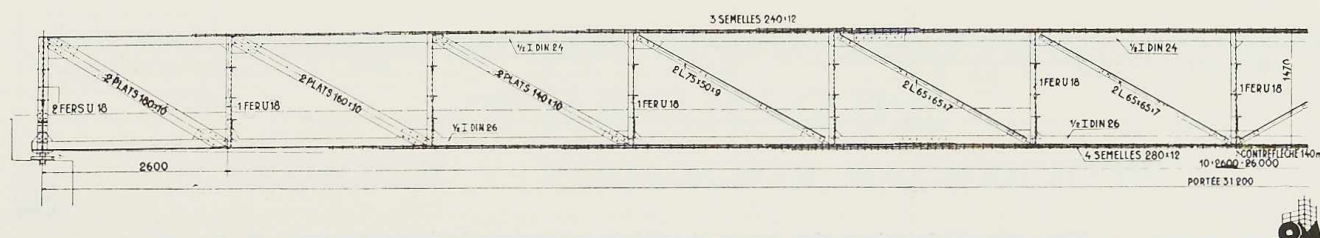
Poutre en treillis du pont de Shoried avant bétonnage.
